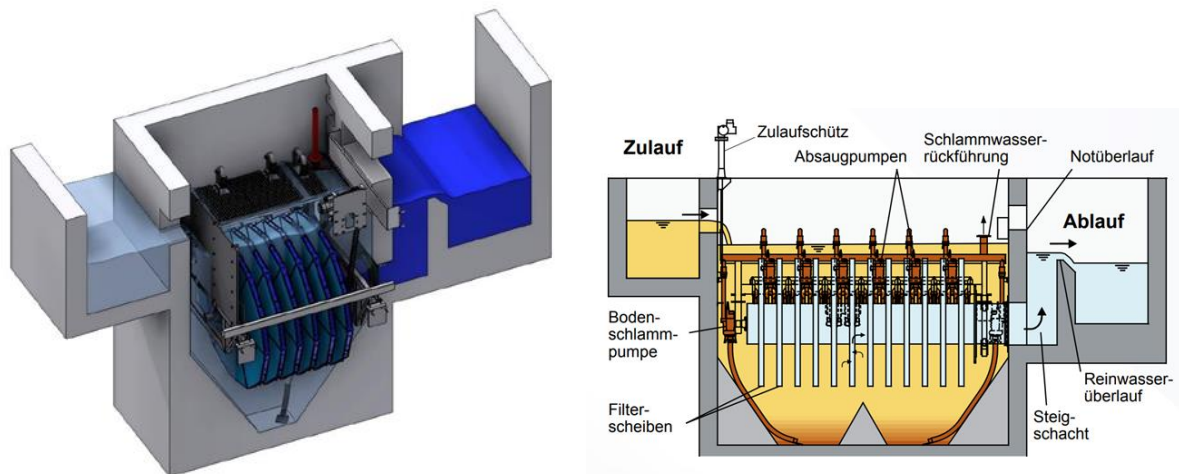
Tuchfilter im Schnitt inkl. Betonbauwerk
